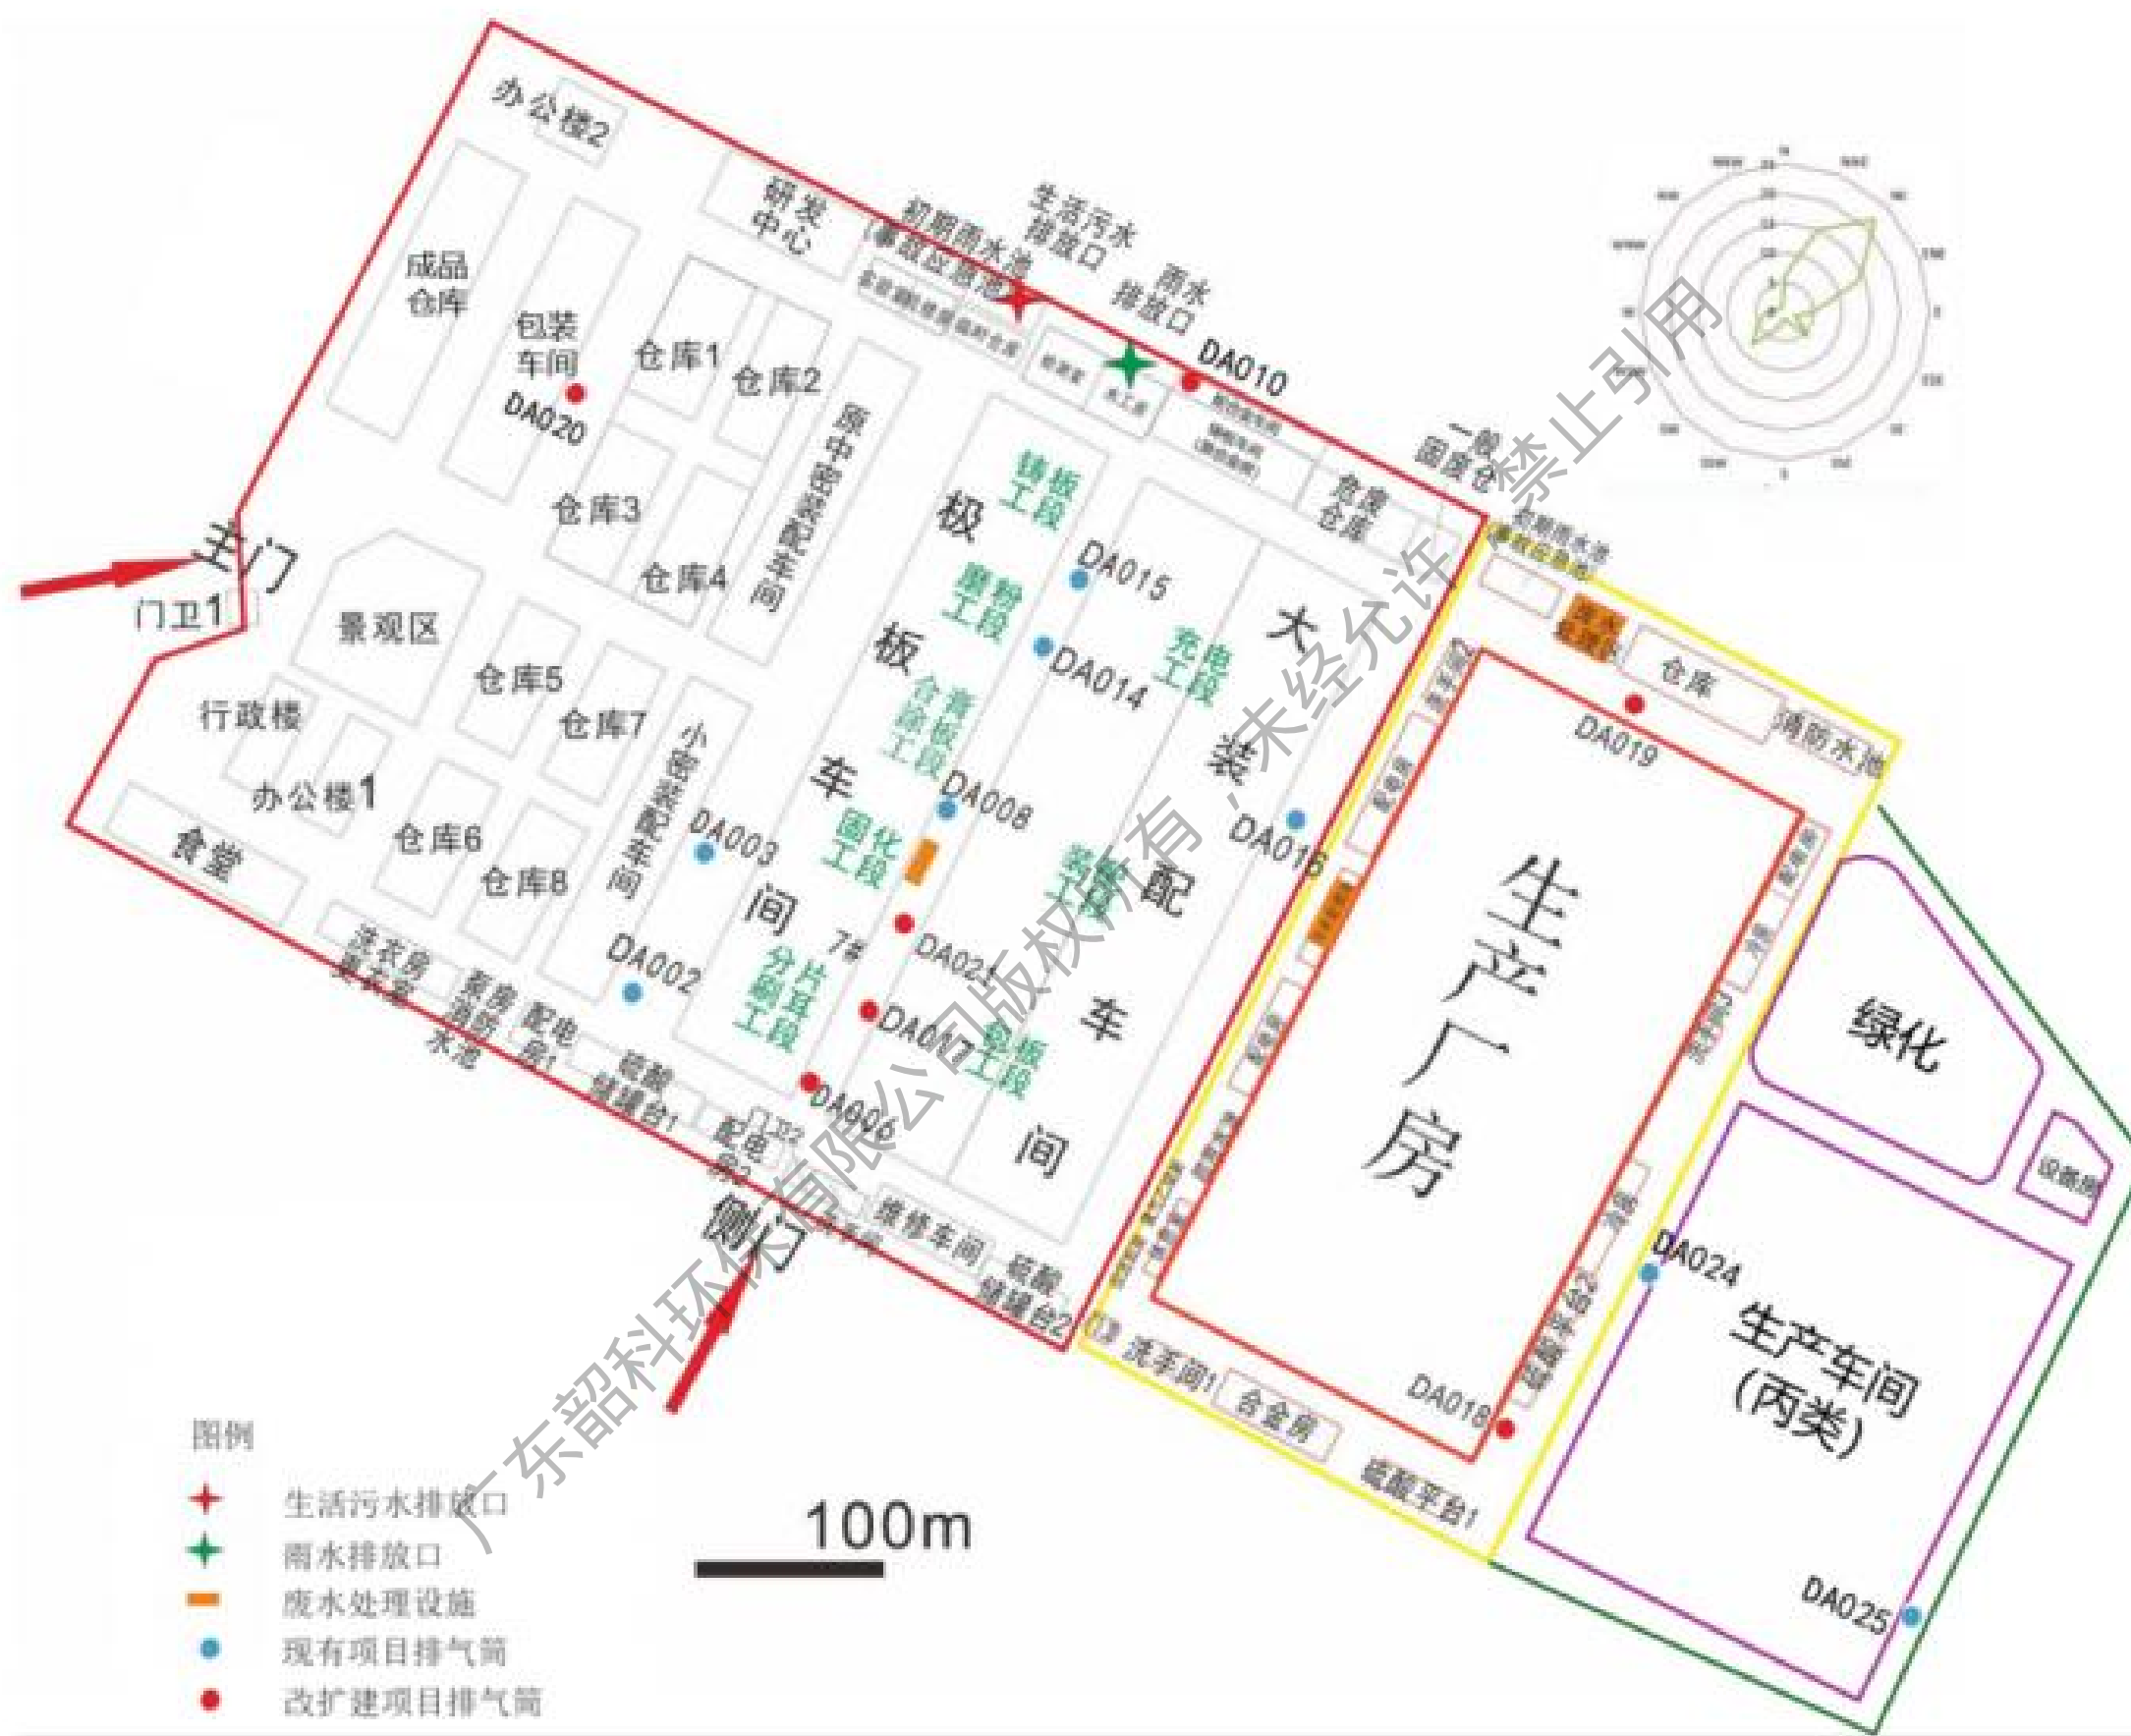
改扩建项目（重新报批）完成后全厂总平面布置图
